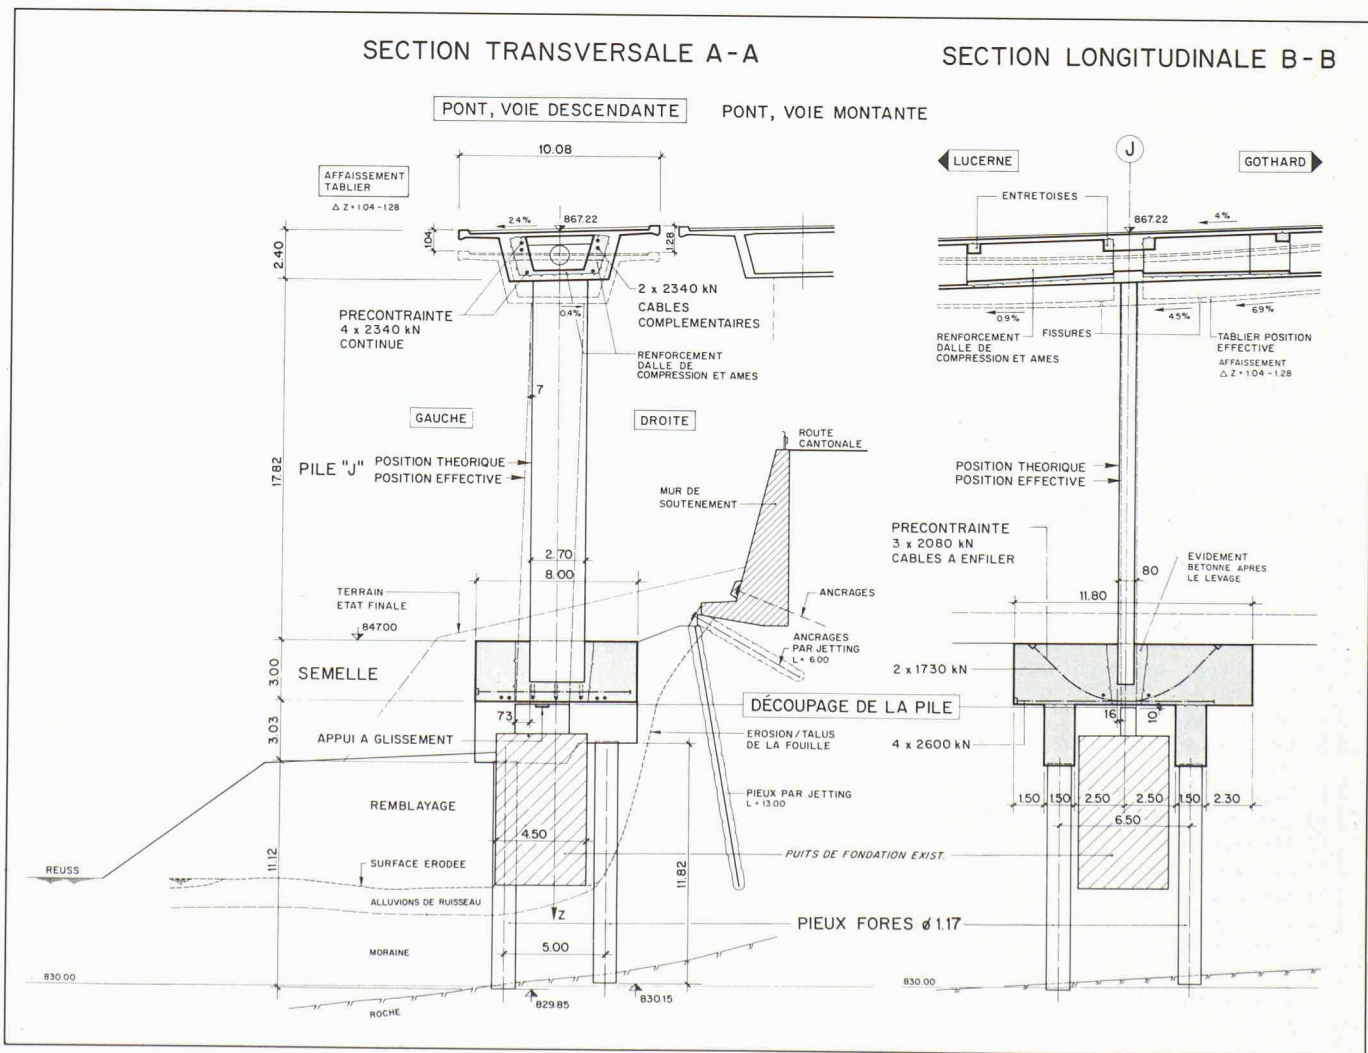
Sections transversale et longitudinale; fondation de la pile J.
